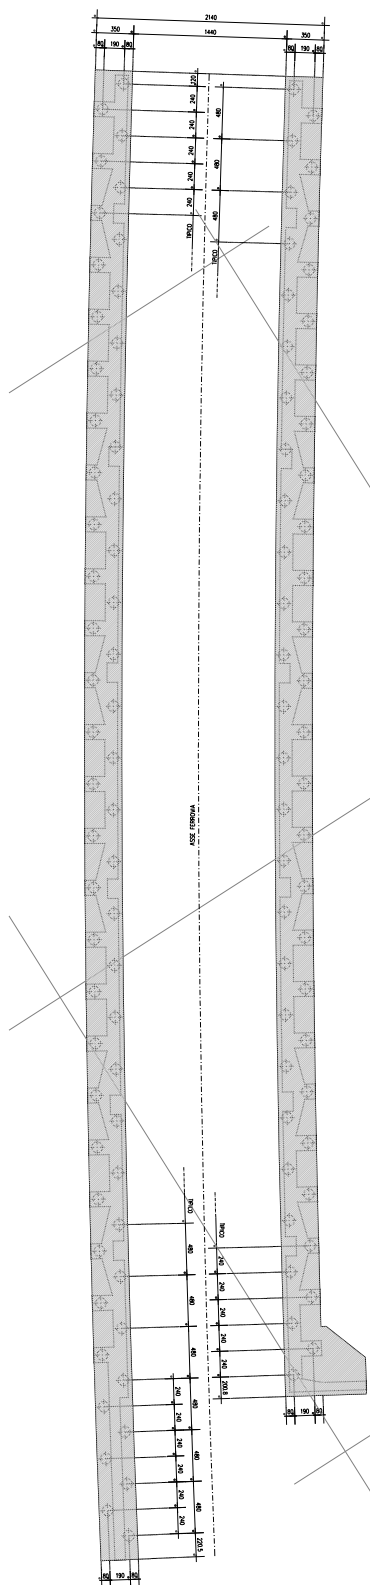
Pianta delle fondazioni della galleria ferroviaria.
